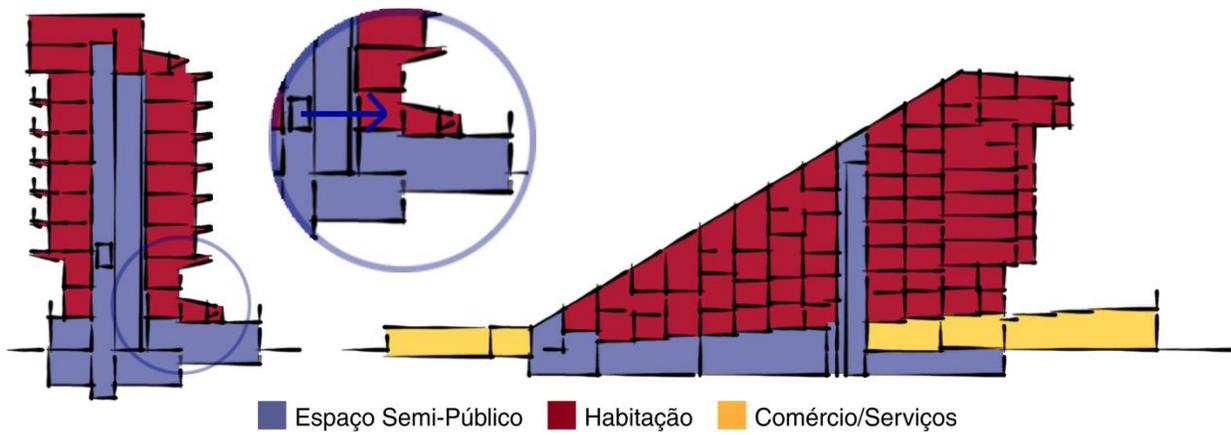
| 8 House - Cortes e detalhe acesso rampas pelos elevadores | Desenho da Autora
